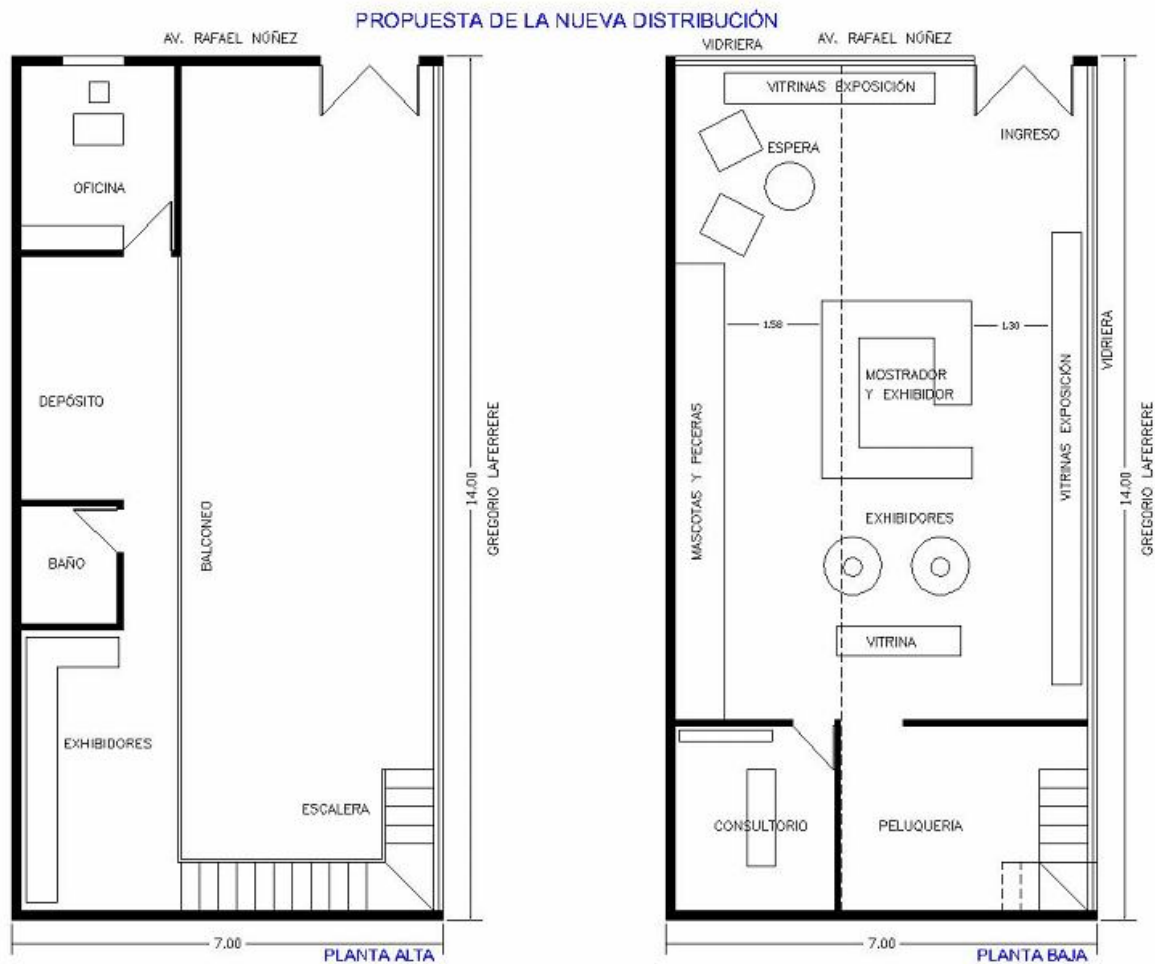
Croquis de la nueva distribución suc. Núñez, planta alta y planta baja⁹³.
